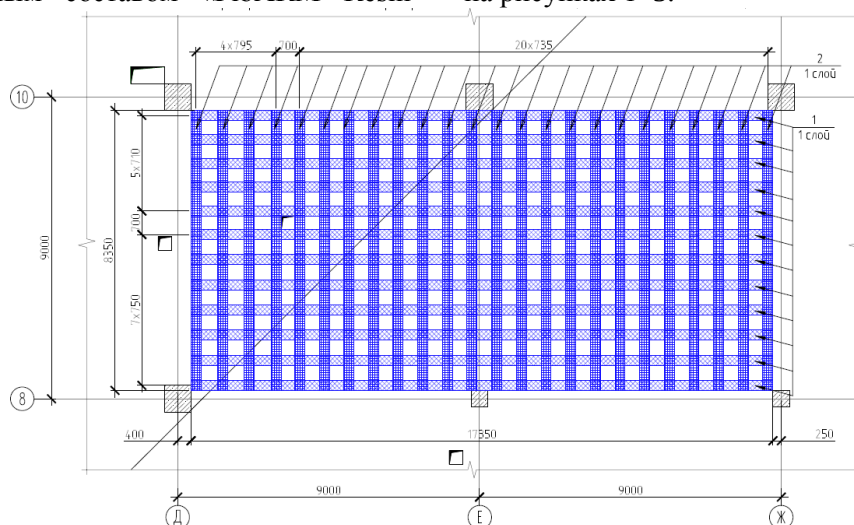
Нижнее армирование плиты перекрытия на отм.-8.100 (наклейка на потолок)
